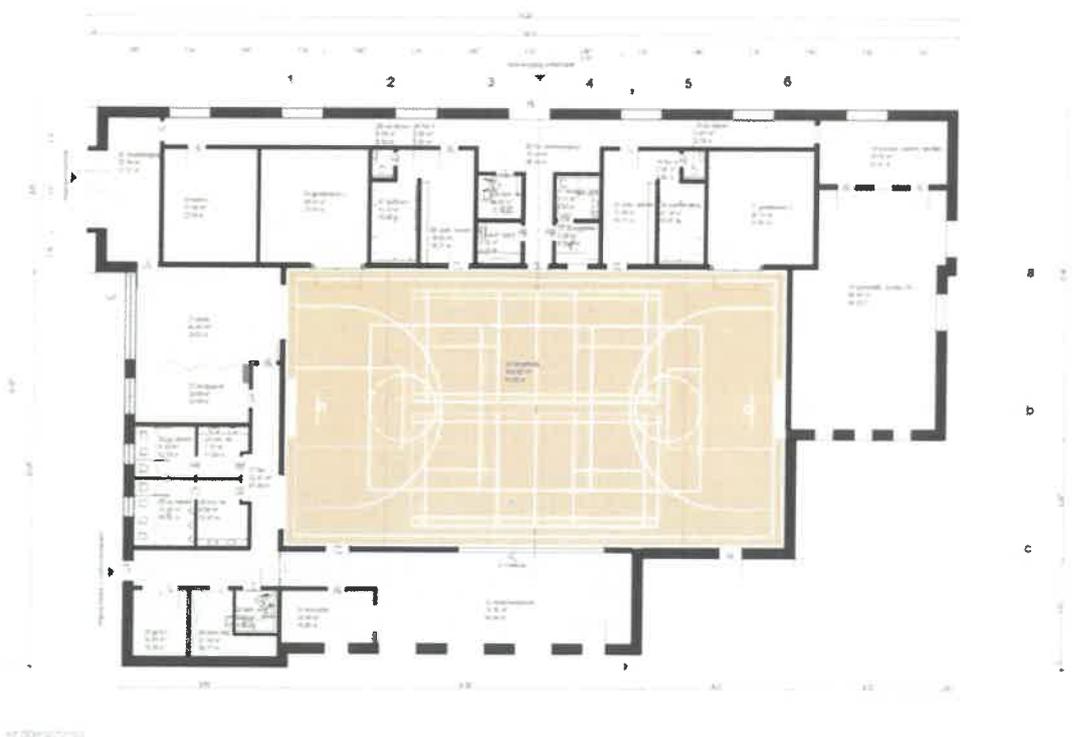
Grundriss zum Neubau der Sporthalle (3ing 2017)
